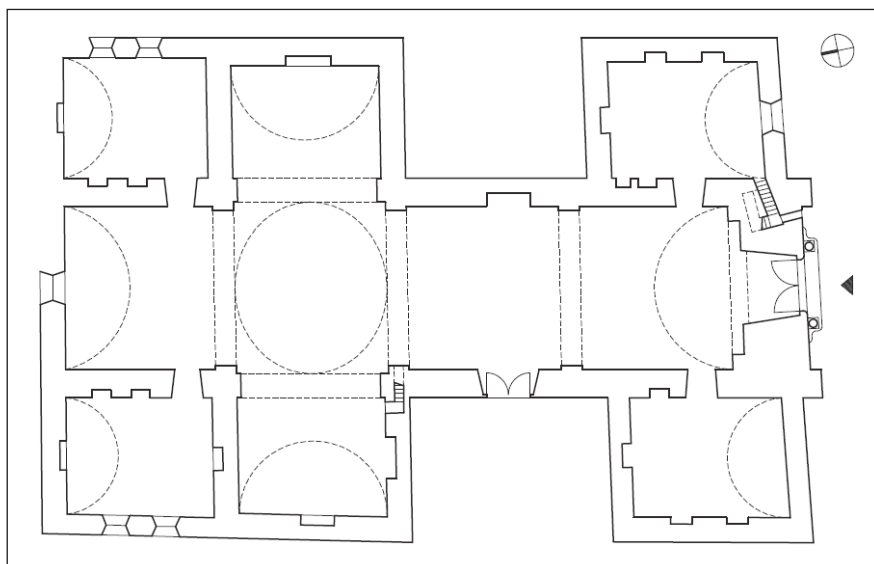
Plano de planta del Templo de San Bernardo (fuente: Potosí Bolivia: Guía de arquitectura 2004: 160).
